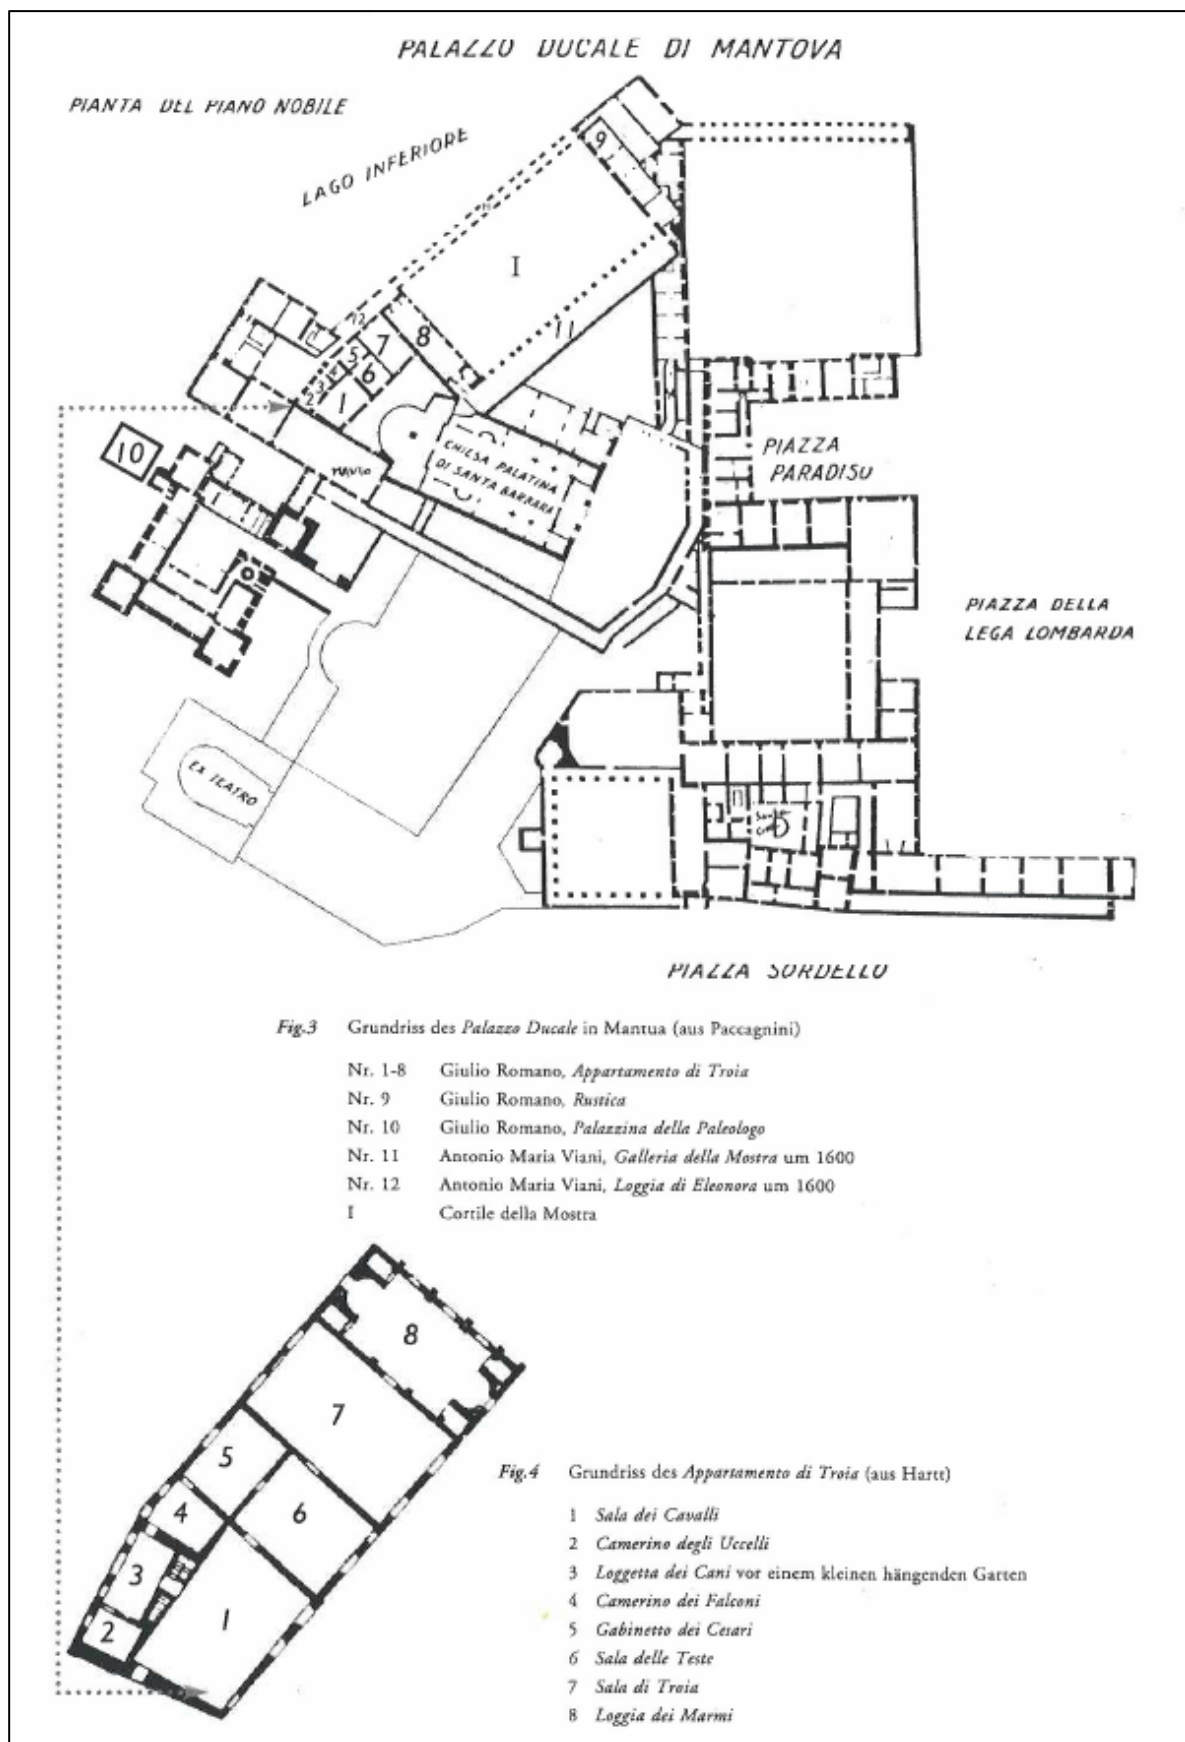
Grundriss des Palazzo Ducale, Mantua.
